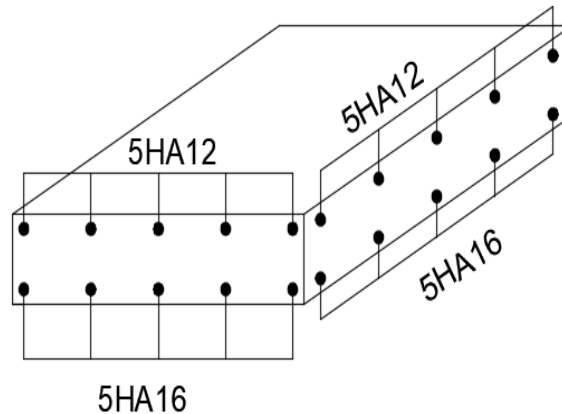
Schéma de ferrailage de la Dalle
